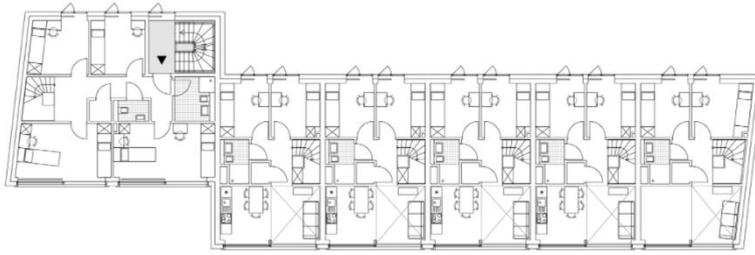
Planta do 2º piso do edifício Henry Korner Hall
